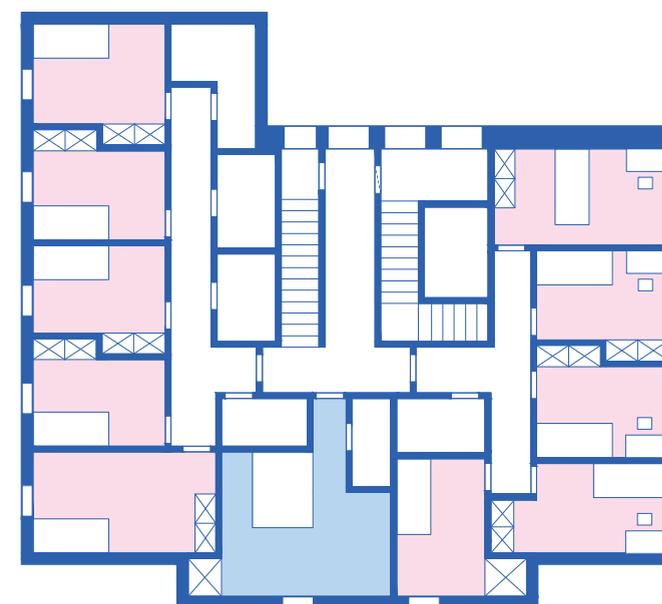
Plan de la Maison des Avants, 1er étage 1:200, 2022
